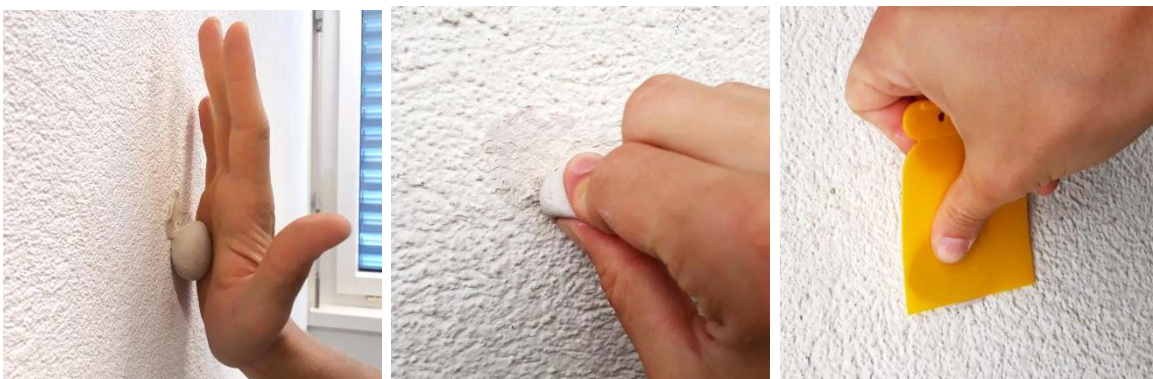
Demontage und Entfernung der Rückstände der Knetmasse. Links: Abrollen mit der Handfläche; Mitte: Abtupfen; Rechts: Ablösen mit einem Spachtel.
